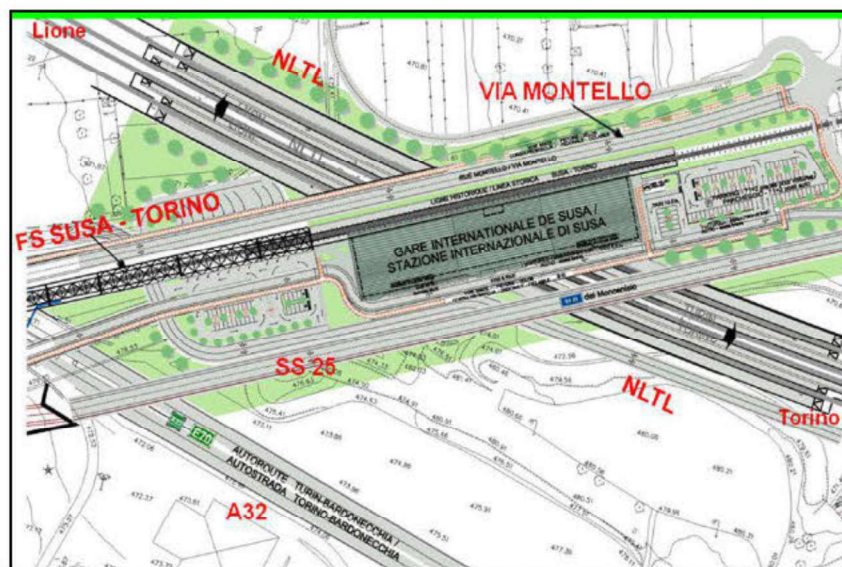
Schema ed inserimento della Stazione internazionale di Susa
